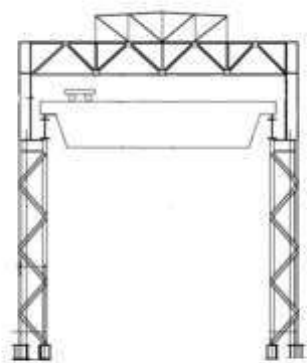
Эскиз сварной металлоконструкции
